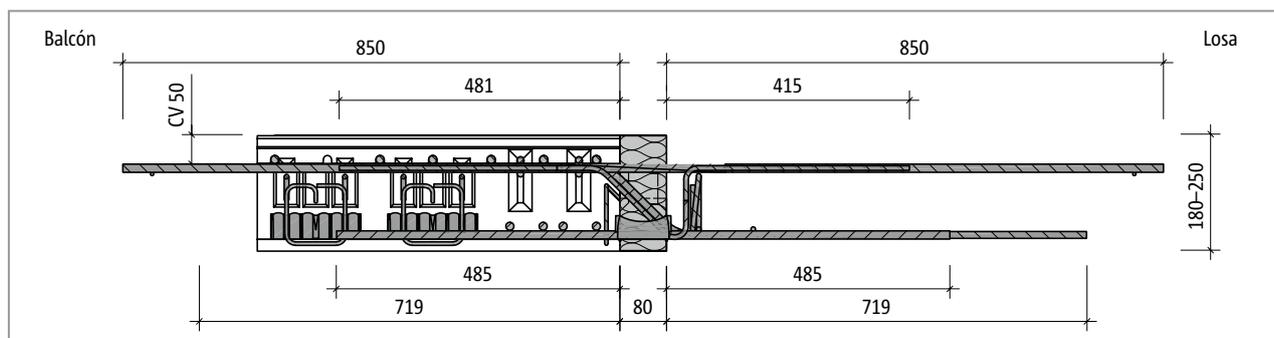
Schöck Isokorb® T tipo C-M3: Sección del producto
